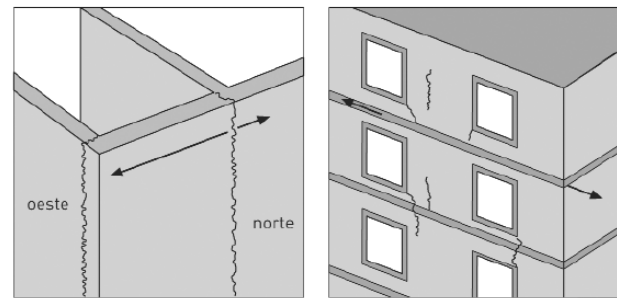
Grietas producidas en la fachada por esfuerzos higrotérmicos (Soria, y otros, 2006)
